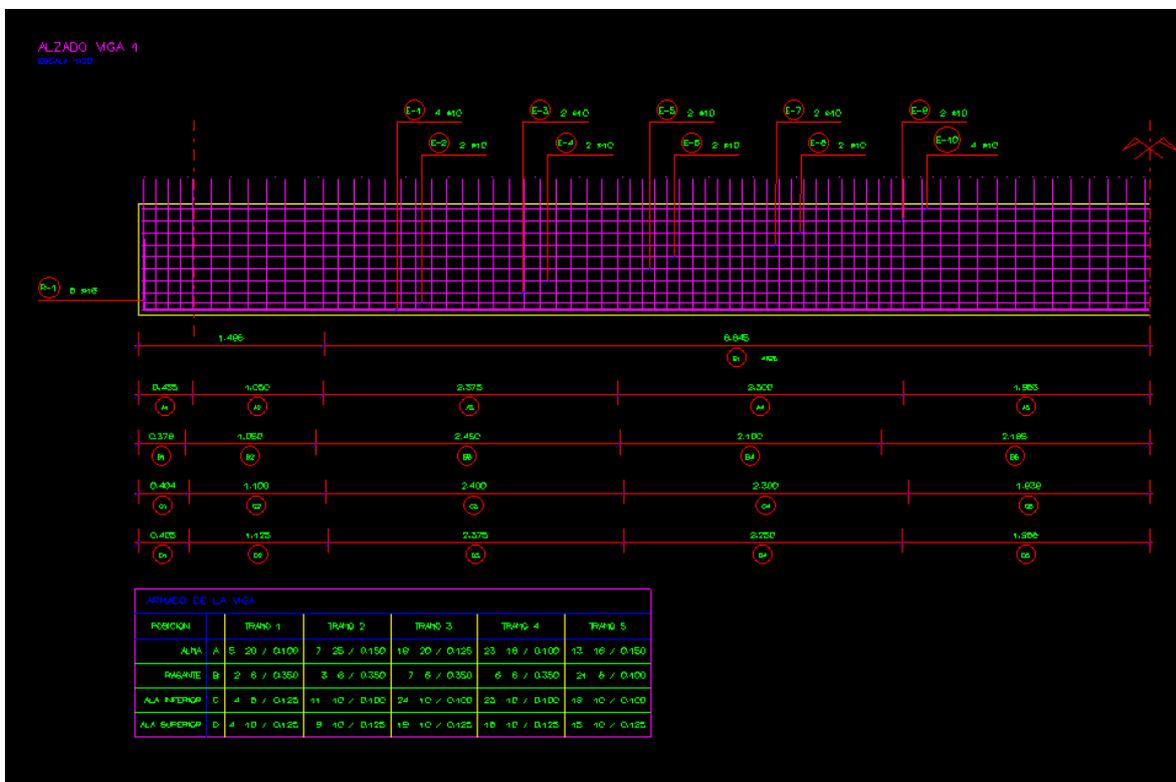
Figura Vigas. Alzado longitudinal.
